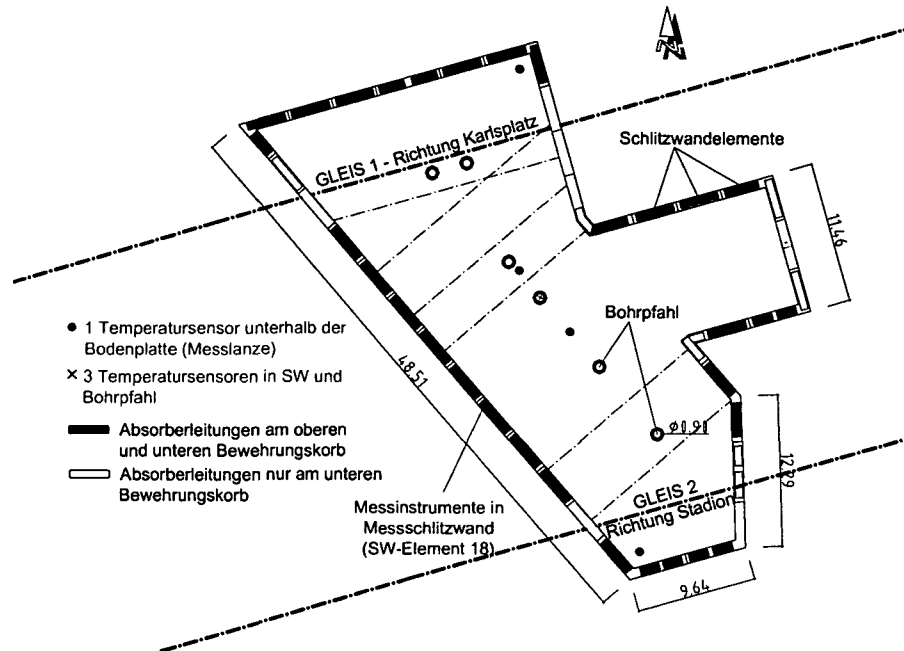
„U2/2-Taborstrasse“ – Schachtbauwerk T – Schlitzwandausteilungsplan (Grundriss). Je nach Lage der Schlitzwandelemente wurden die Absorberleitungen entweder zur Gänze oder nur am unteren Bewehrungskorb montiert. Zu sehen ist außerdem die Lage der eingebauten Messgeräte.
